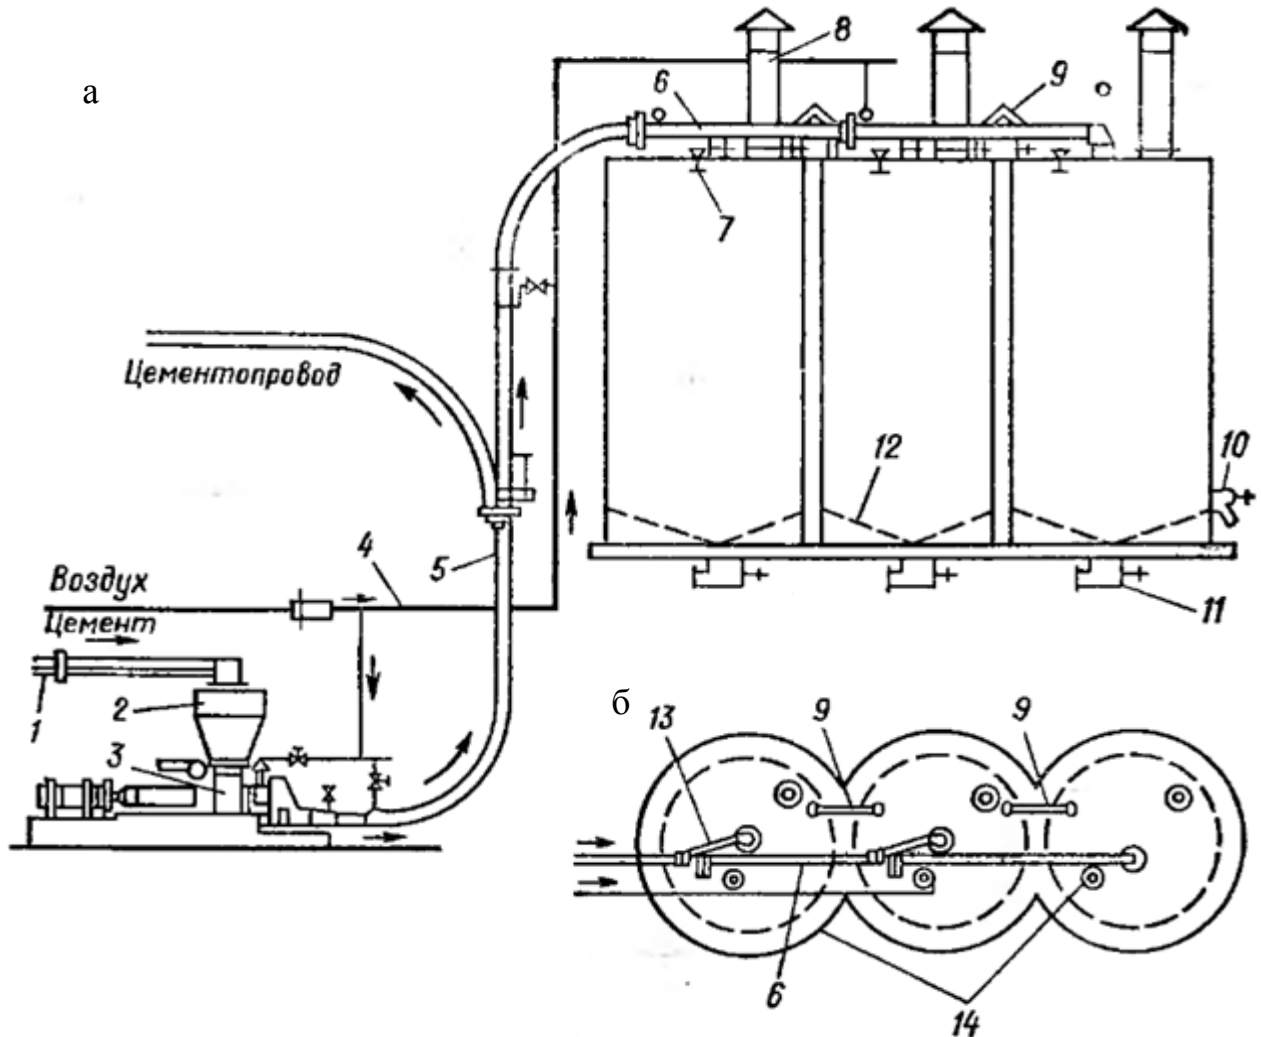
Силосный склад цемента: а – принципиальная схема установки и обвязки оборудования; б – фрагмент плана
